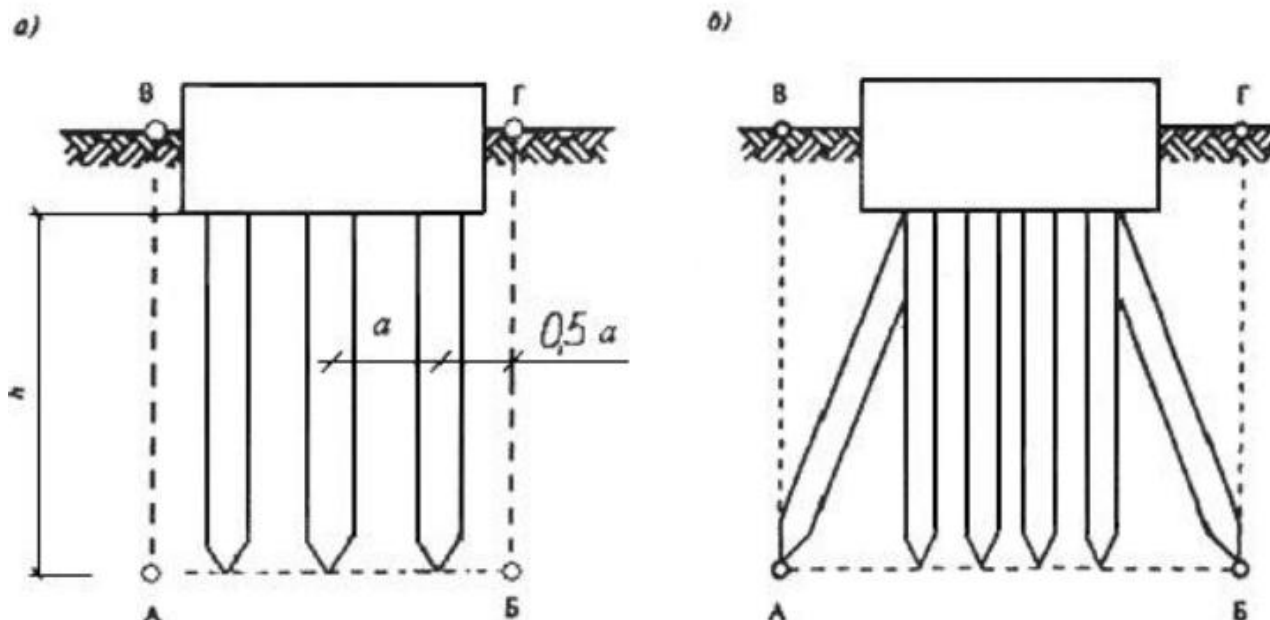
Определение границ условного фундамента при расчете осадки свайных фундаментов
